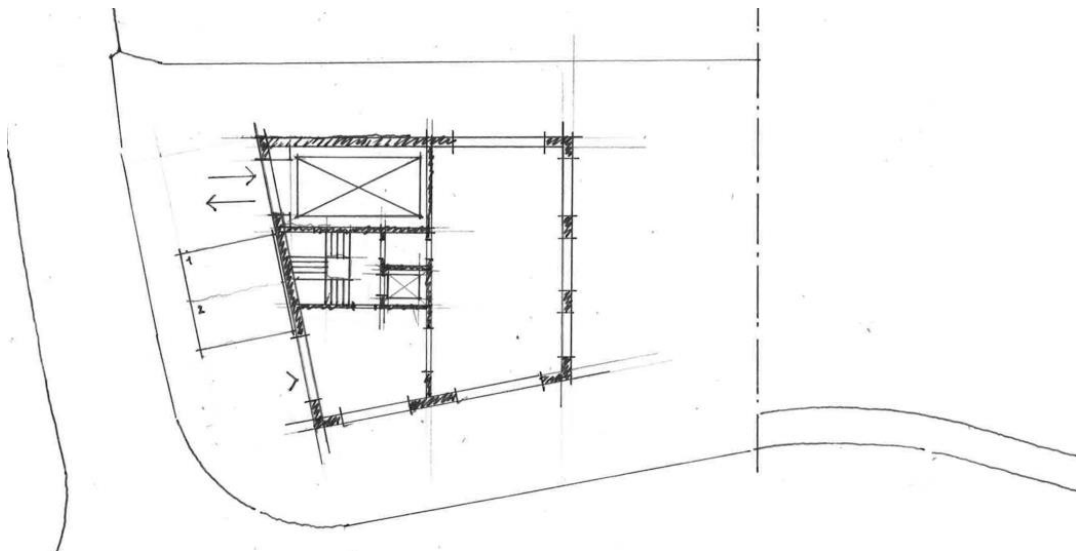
Skizze sekundäre Zufahrt mit Autolift, Erdgeschoss (Stoos, 2018)
